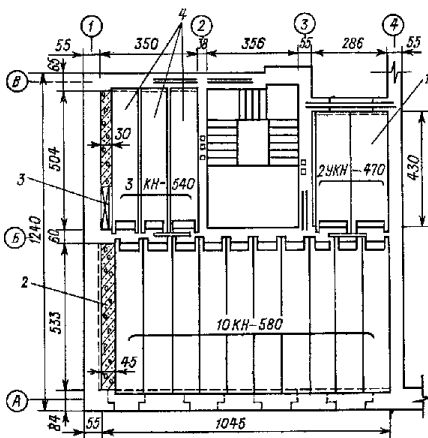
План участка перекрытия из железобетонных двухпустотных настилов КН
